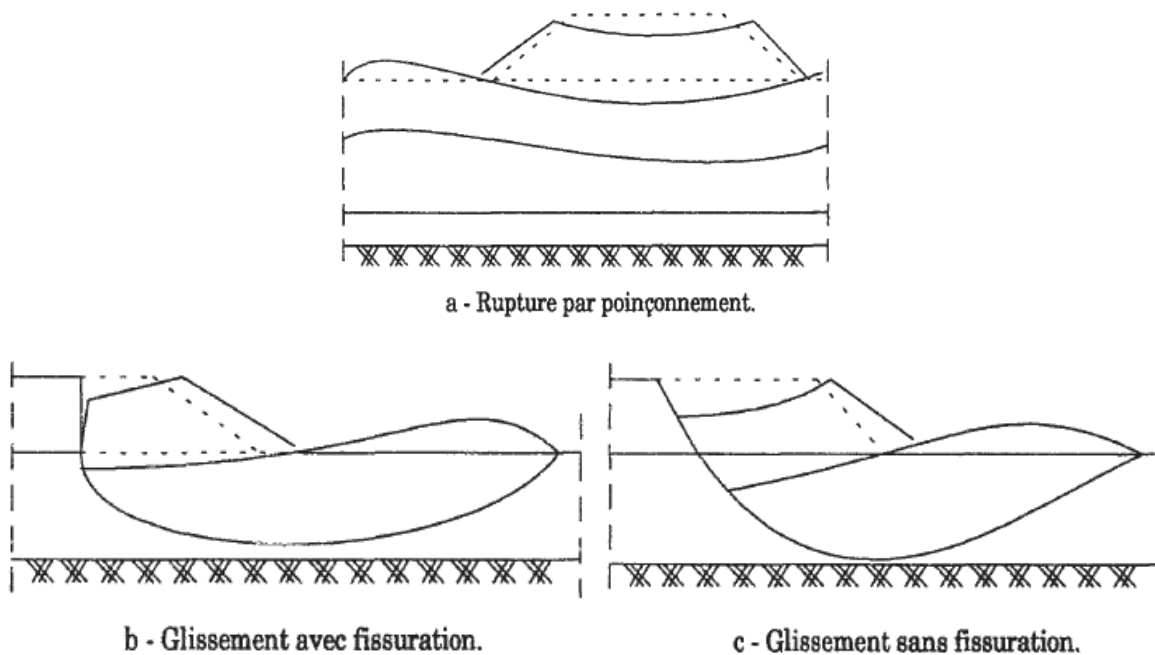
Cas d'instabilité d'un remblai sur sol compressible
